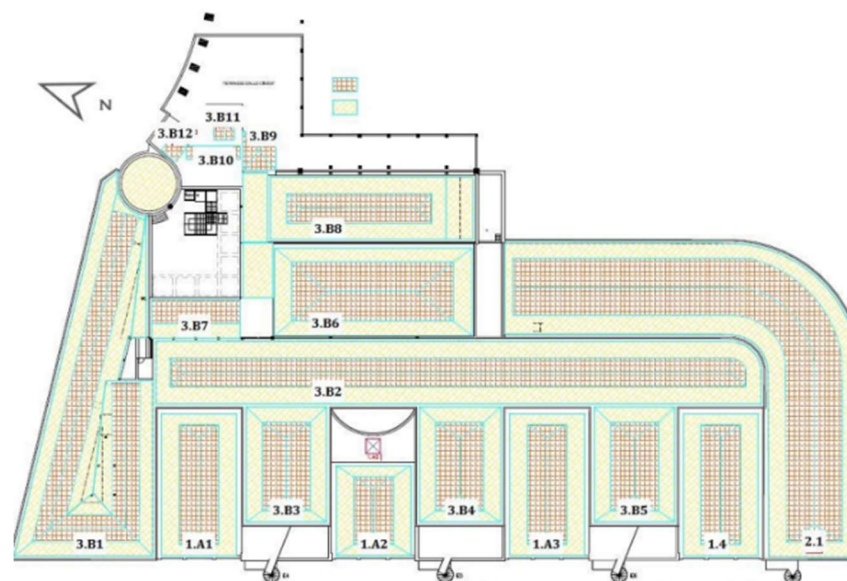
Extrait Audit Marc PROVENDIER - Plan de repérage des zones auditées
